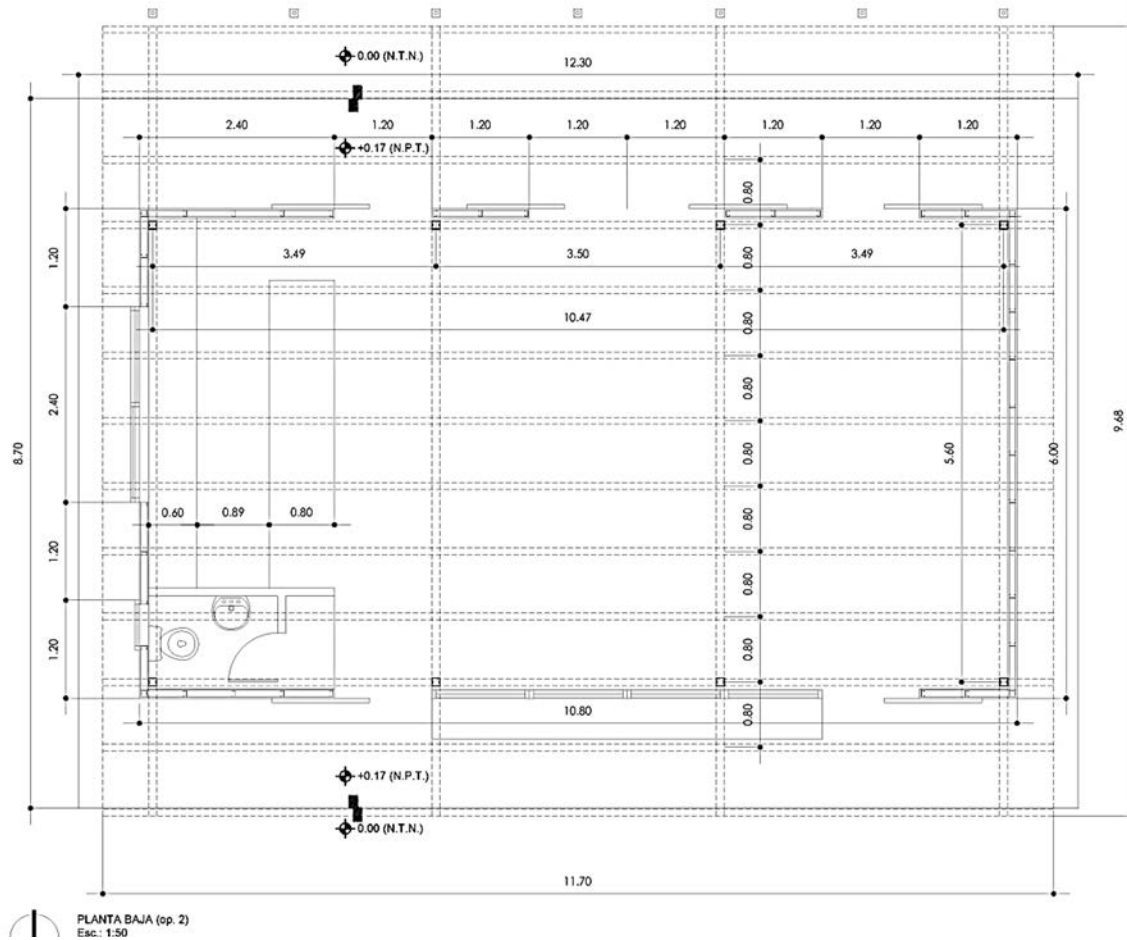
Planta general del Salón de Usos Múltiples (SUM)..
